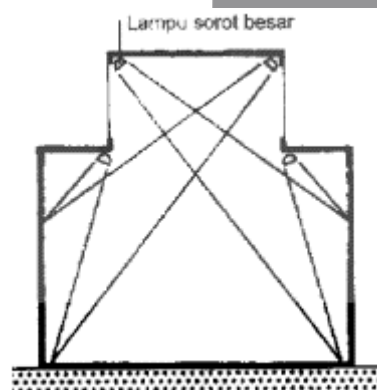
(d) (Sudut Pandang Dengan Jarak Pandang Ruang)
